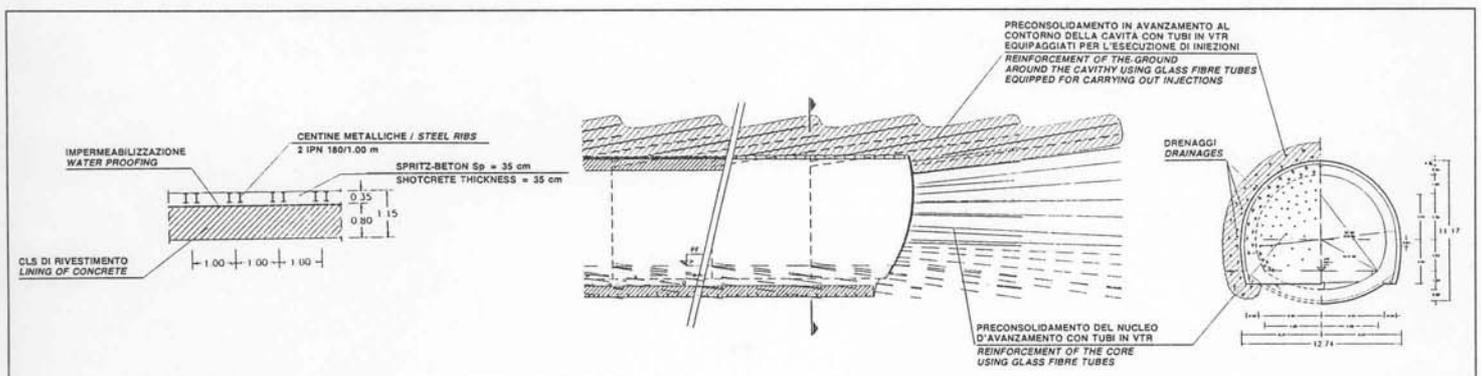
Esempio di sezione tipo C4 (fig. 13), longitudinale e trasversale
